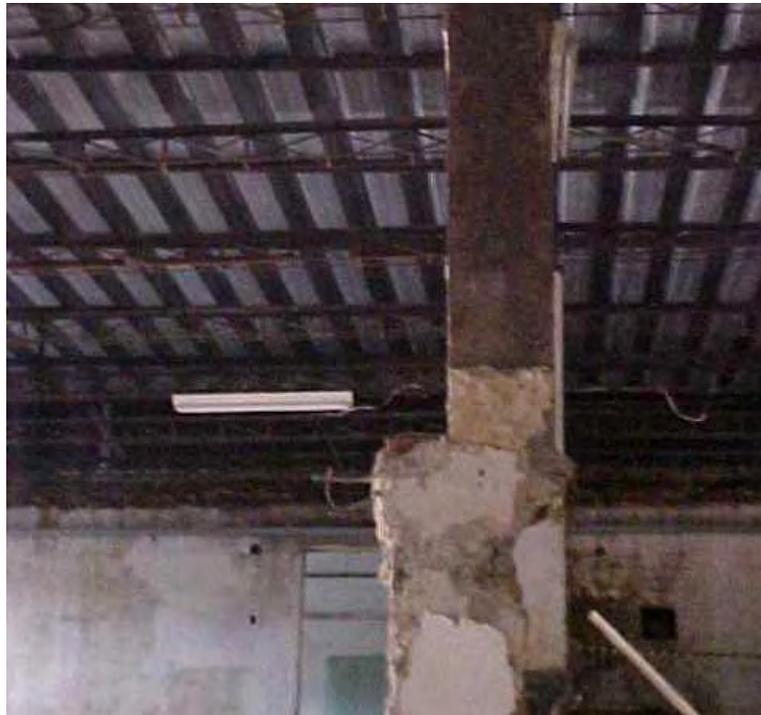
Pilar com grande excentricidade apoiado em alvenaria não estrutural
